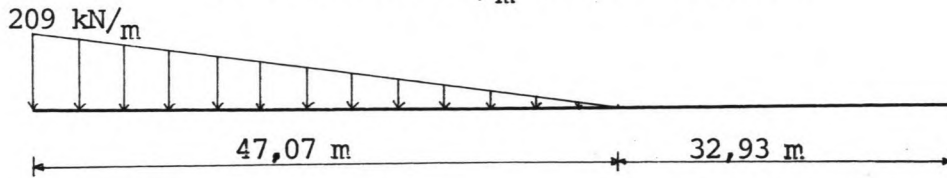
B : Dit gewicht kan er maximaal aan ballastwater bijkomen. Door twee trams kan er overigens nog 89 kN/m bijkomen.
